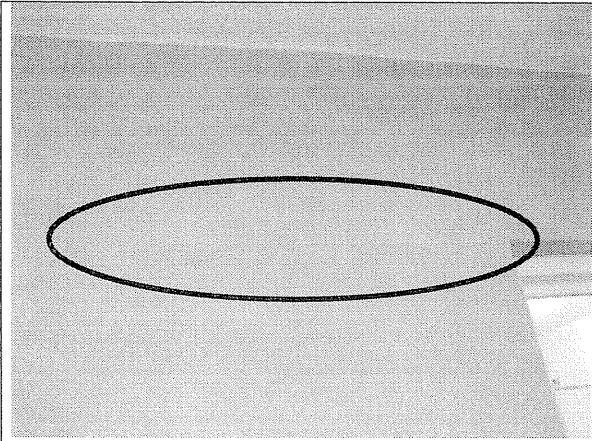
Fisura en muro interno de pisos superiores.
